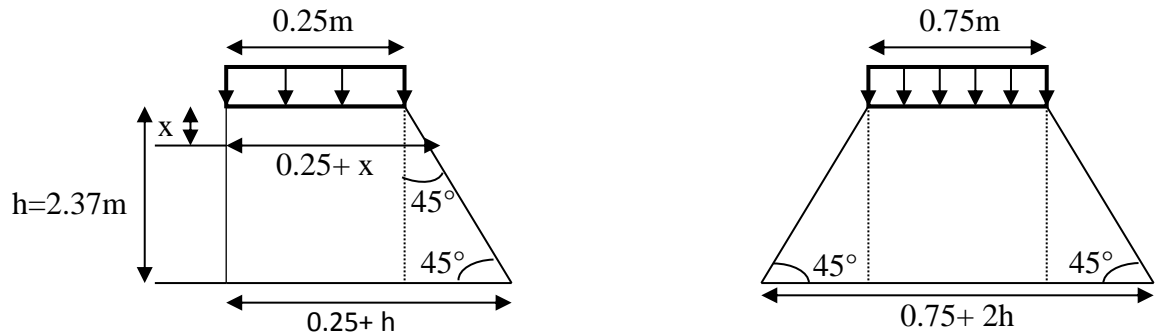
Poussée de la charge locale située en arrière du mur.
